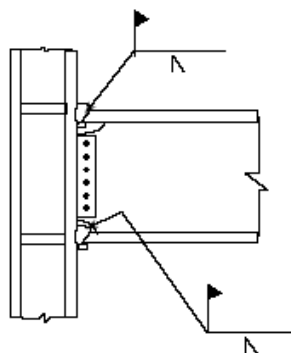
Conexión soldada a momento típica de vigas de sección I con columnas de sección I (adaptada de FEMA 355 D, 2000).
